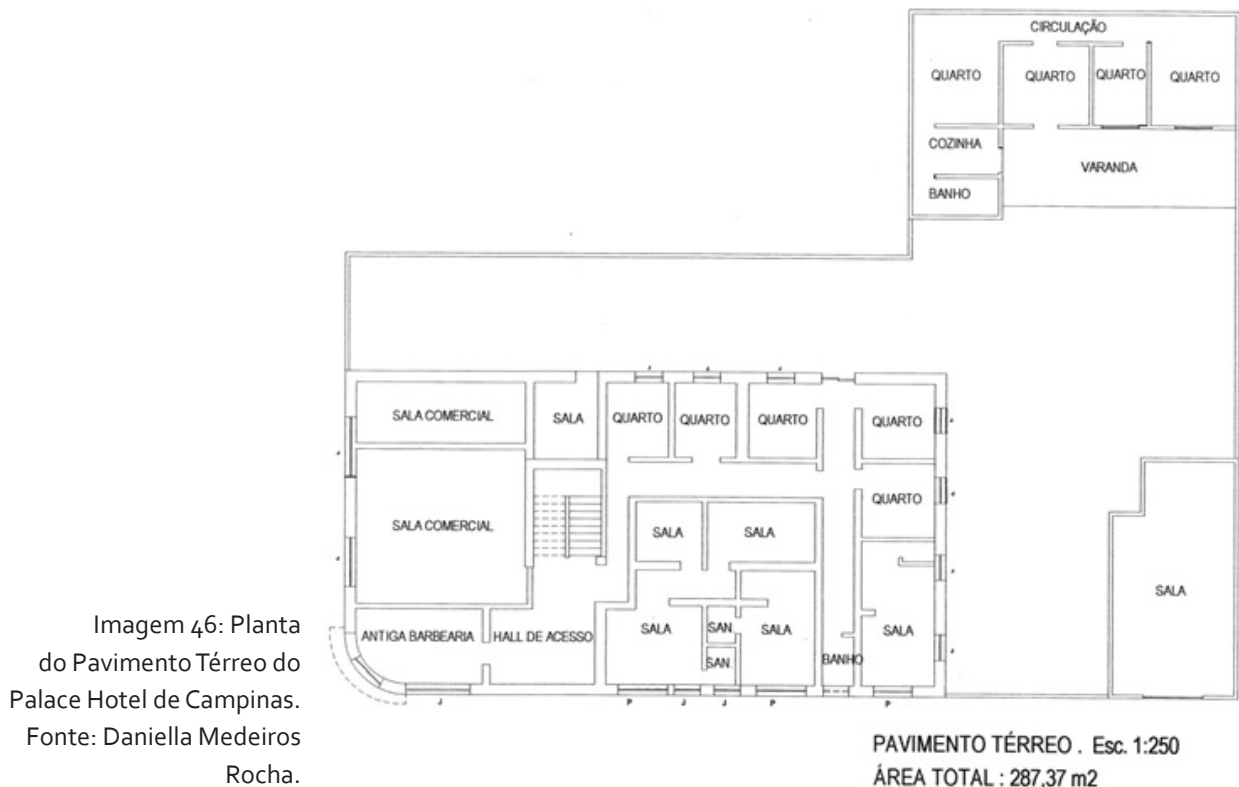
Planta do Pavimento Térreo do Palace Hotel de Campinas.
